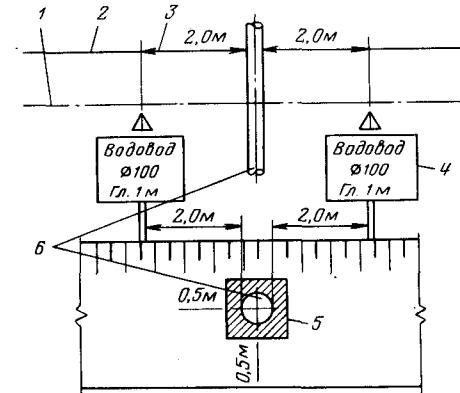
Схема разработки грунта вблизи подземных коммуникаций:
